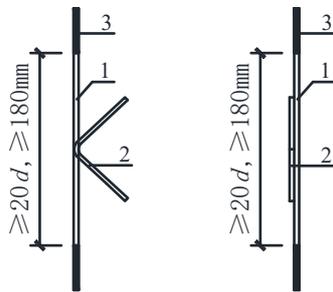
钢筋桁架、钢筋支架拉伸试件
